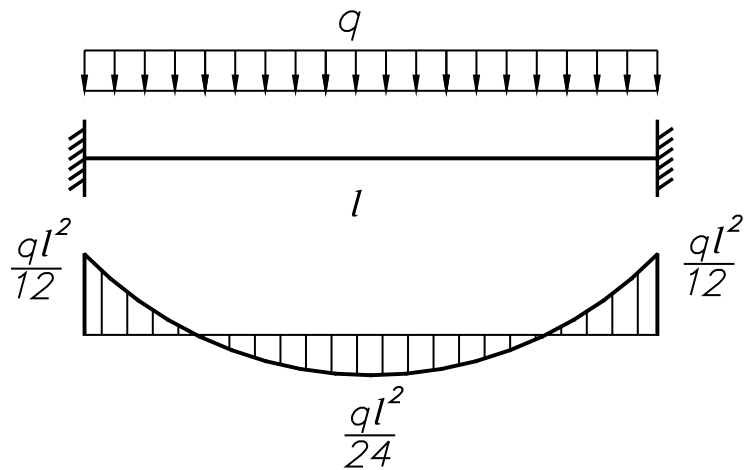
Расчетная схема каждого пролета с эпюрой изгибающих моментов
